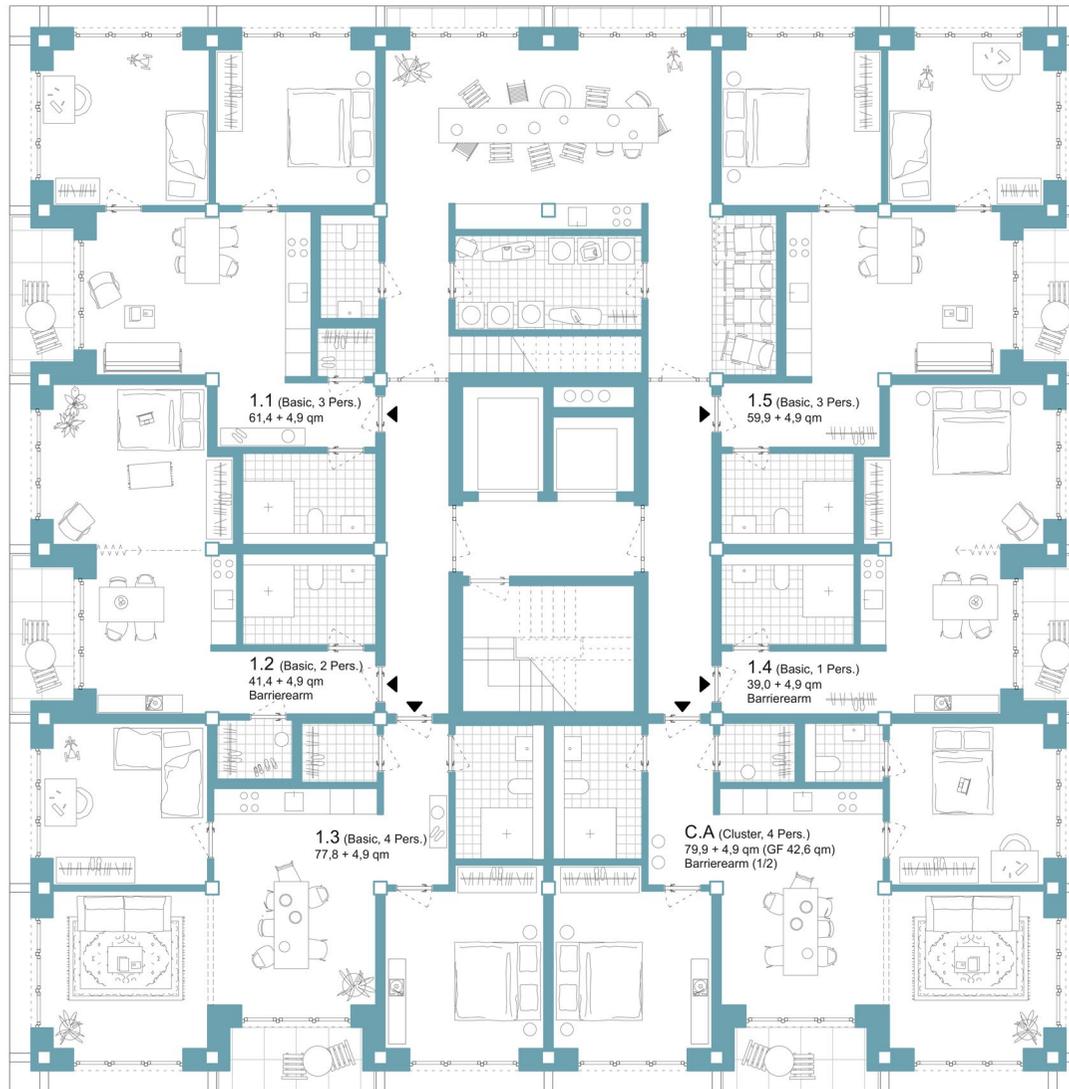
Regelgeschoss | M 1:175 | Studio ELE (Köln)
